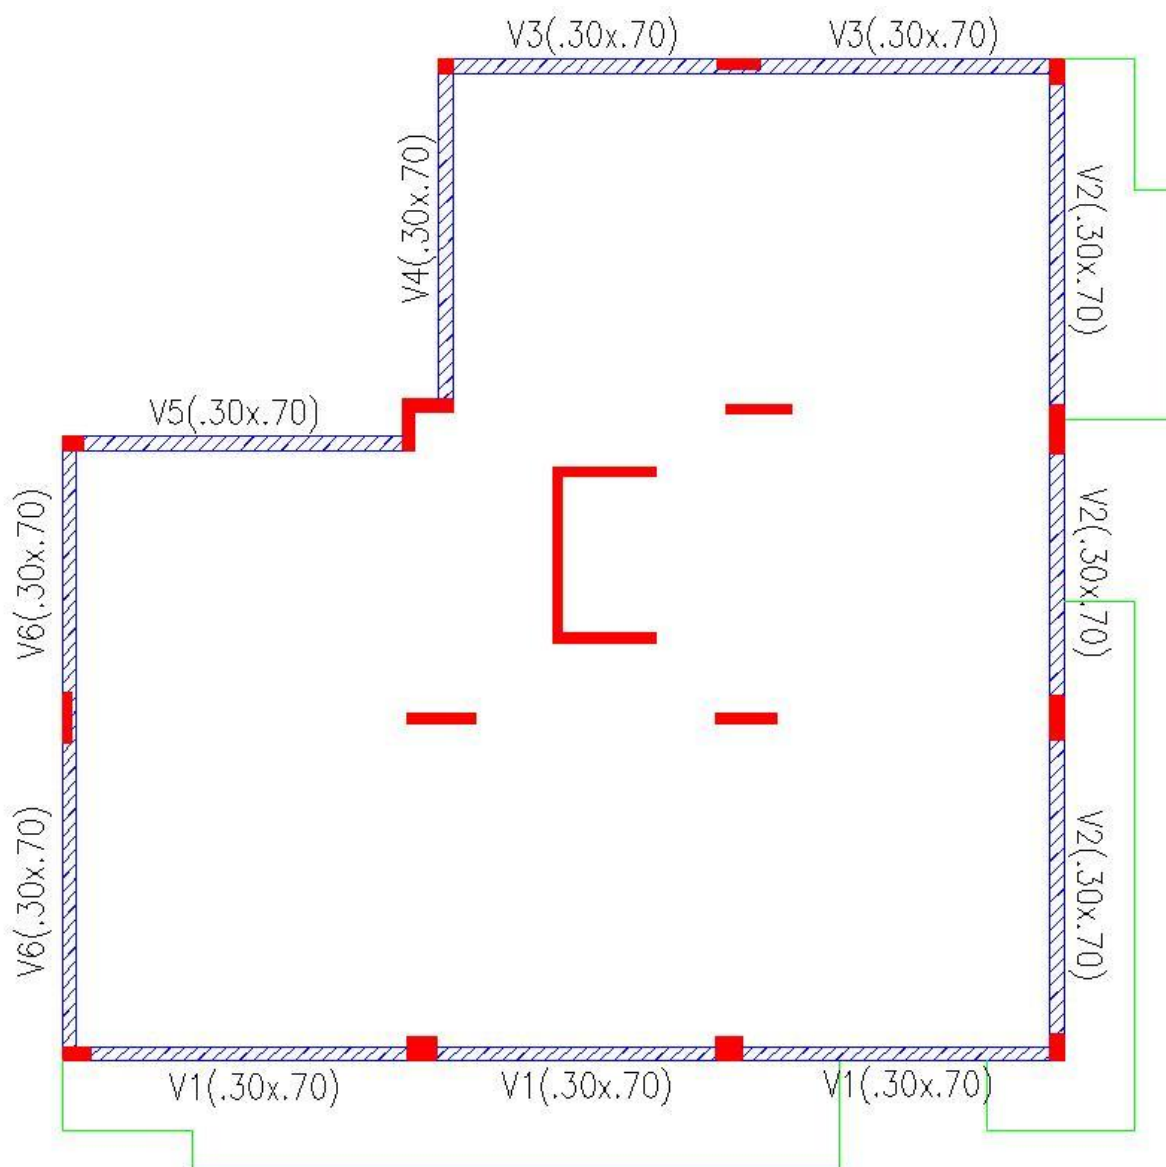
Disposição e dimensões das vigas no piso tipo
